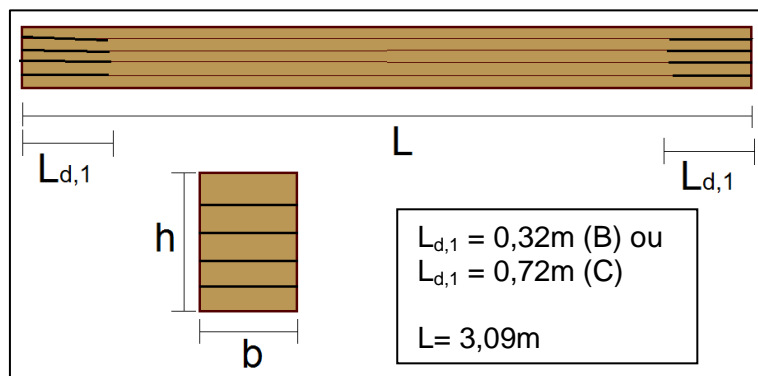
Esquema de delaminação das vigas "B" e "C" (delaminações a risco espesso)
